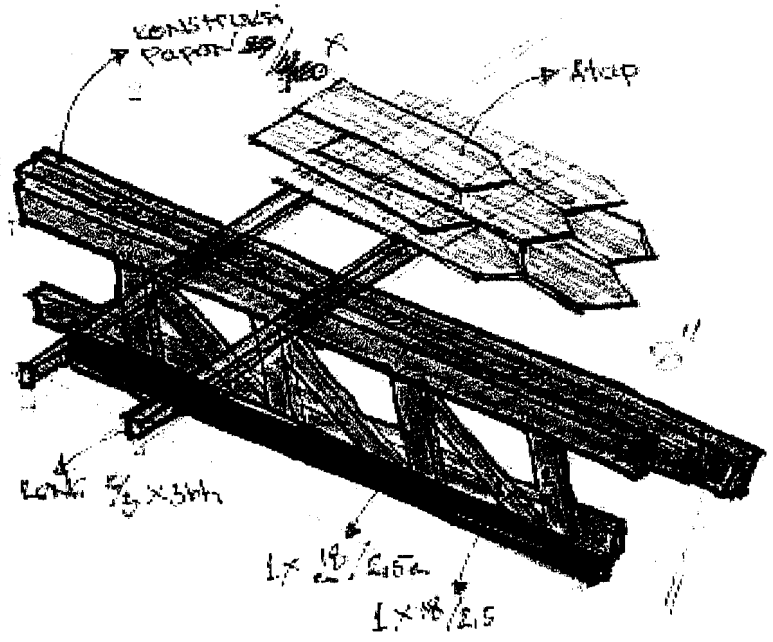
### DETAIL SAMBUNGAN STRUKTURAL PONDASI
